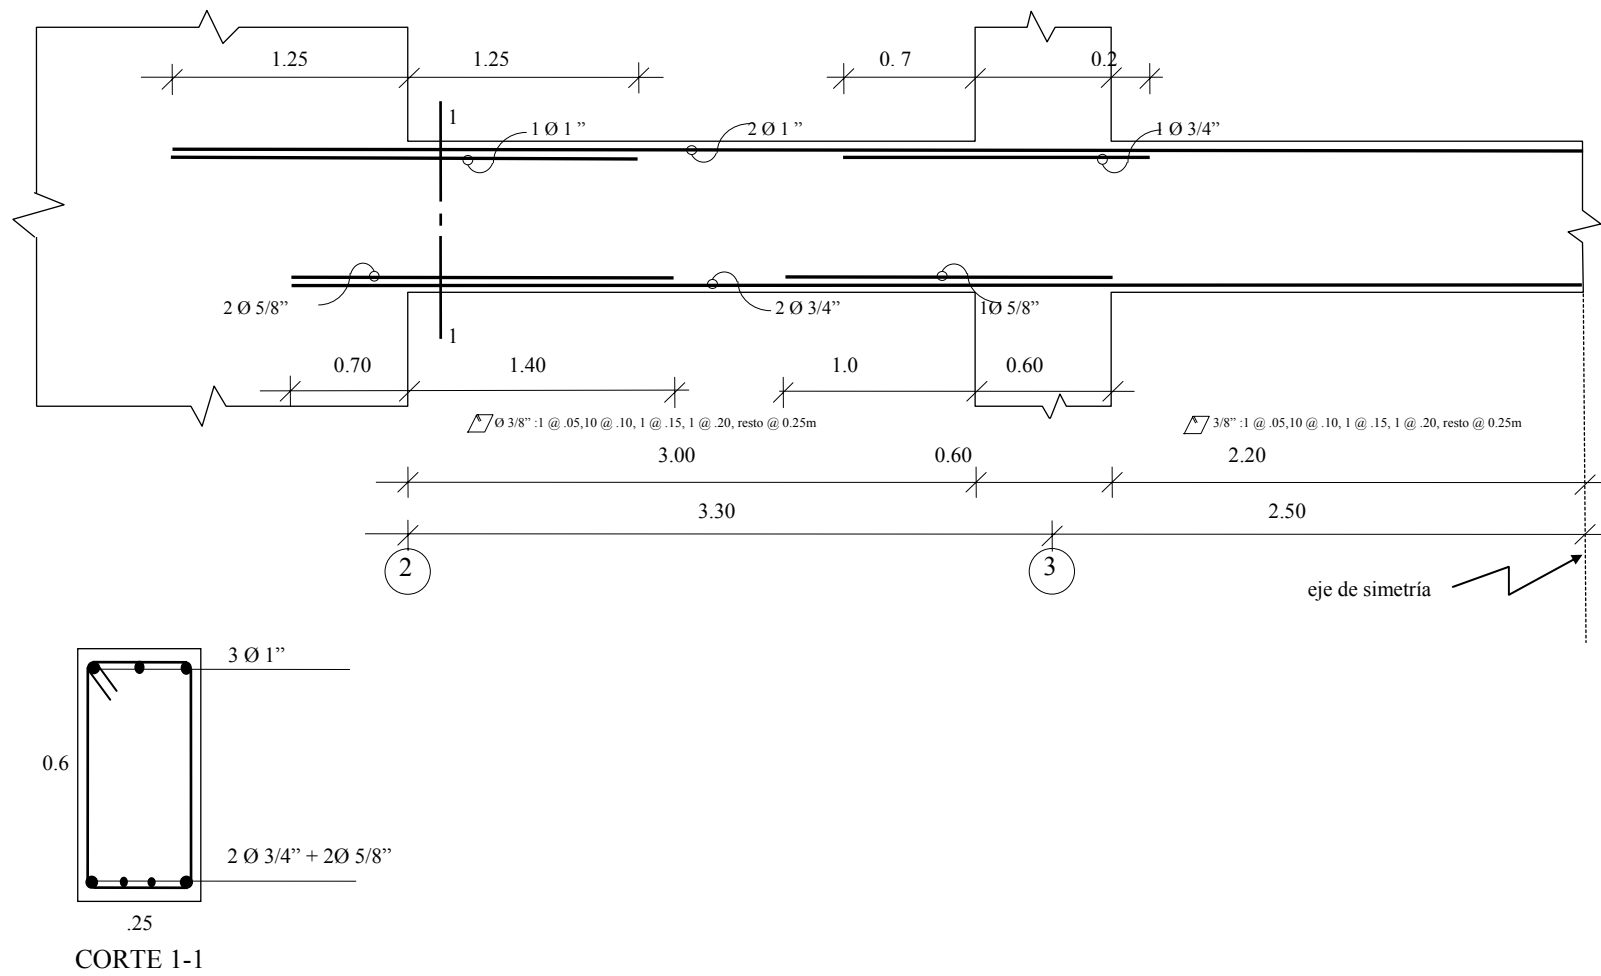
Detalle del refuerzo - viga eje B - Niveles 3° - 8°
